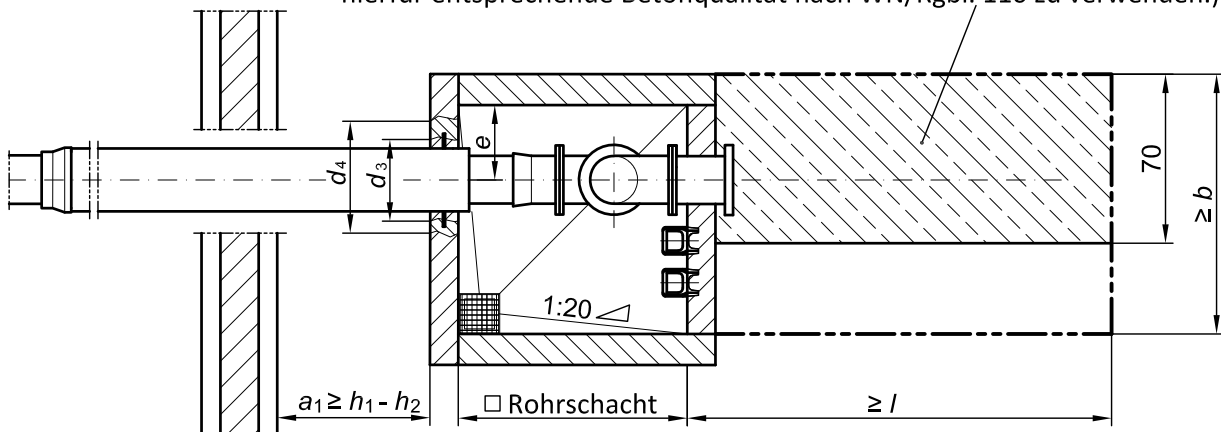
Anordnung Rohrschacht und Einbauraum bei geplantem Gebäude
